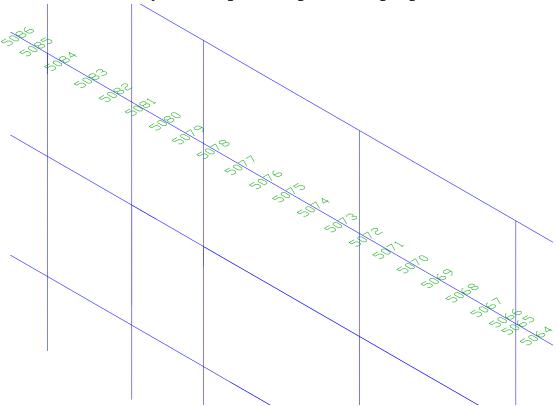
Обозначение элементов ригеля перекрытия по оси 8
